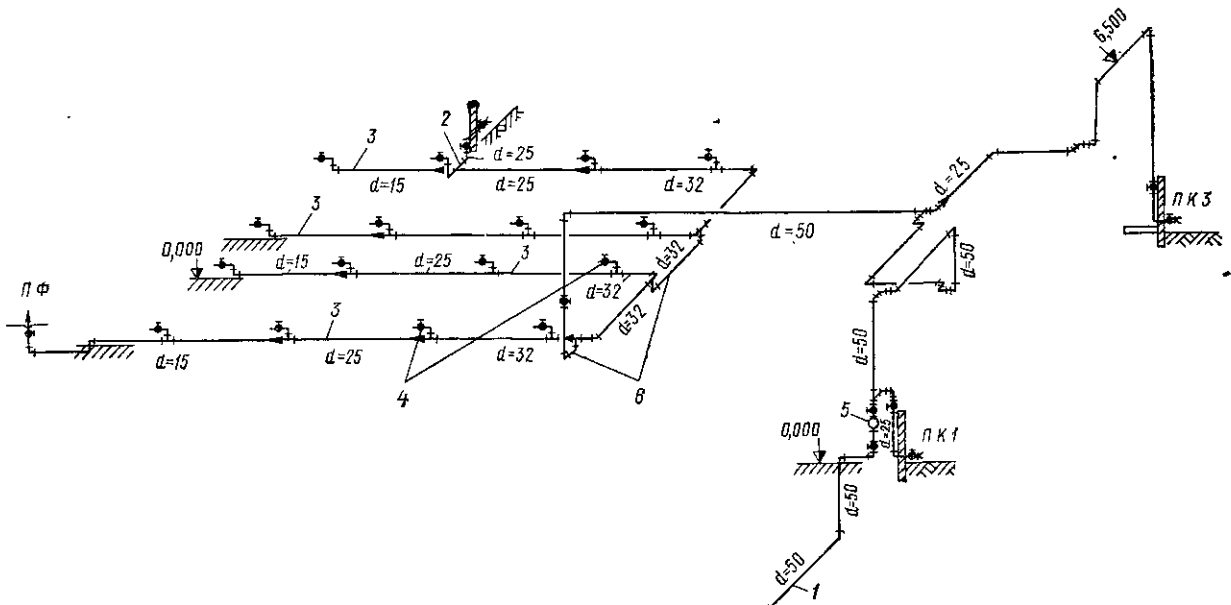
Схема производственного водопровода завода железобетонных изделий
